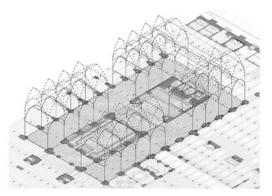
Sobre la referencia tipológica catedralicia anterior, en el lugar de las naves menores o laterales aparecen unos tramos reconstruidos de la mezquita con abovedamientos góticos. Realizado sobre planimetría
